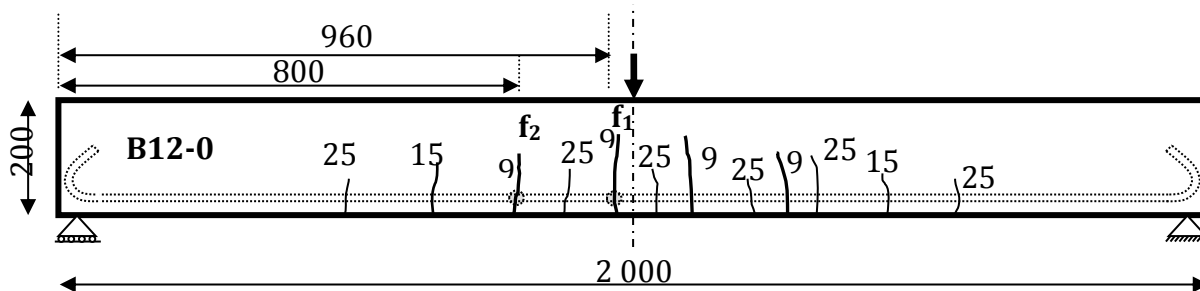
Cartes des fissurations de la poutre B12-0 au niveau de pré-chargement de 13.5 kN.m.
